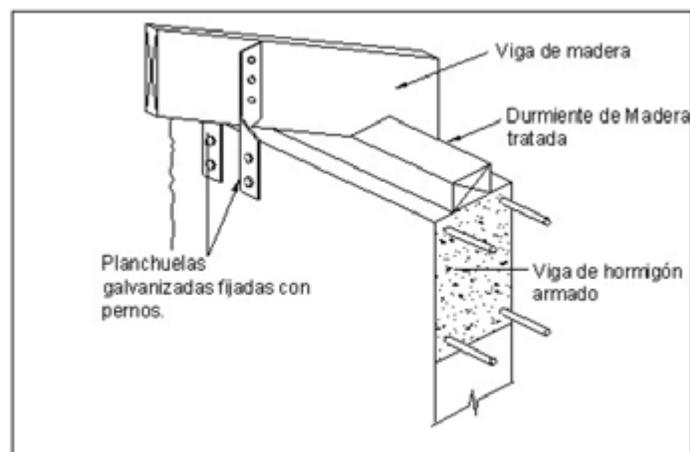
ACCESORIOS METÁLICOS, UNIONES VIGAS Y VIGUETAS DE MADERA
